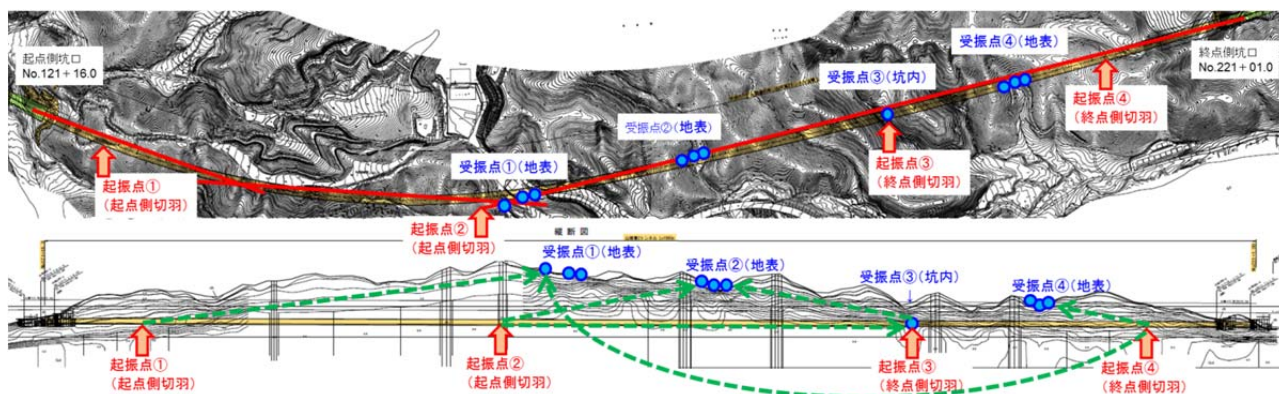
起振点および受振点位置図および対応関係(平面図, 縦断図)
